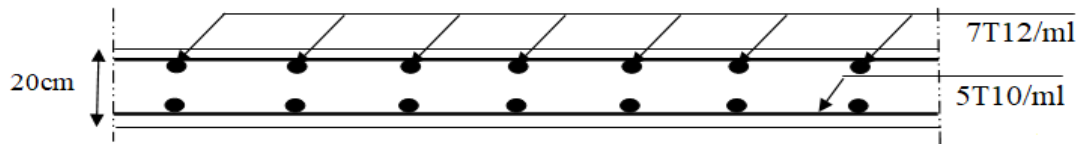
Coupe horizontale du ferrailage du voile périphérique
